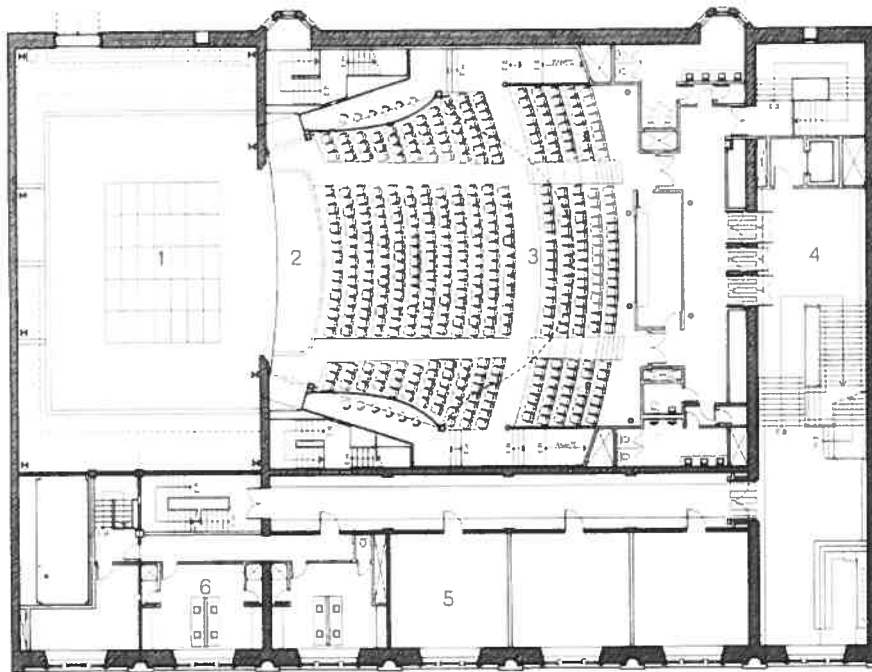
Plan du troisième étage, niveau salle Ludger-Duvernay.
